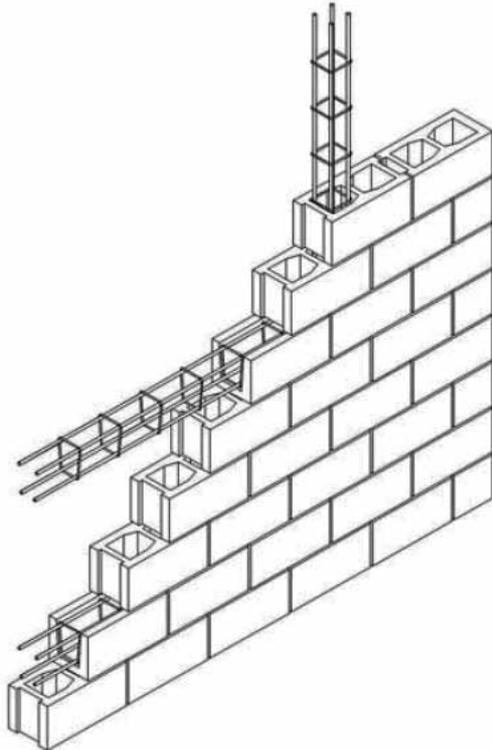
Muro de bloque con zunchos y pilastras interiores de hormigón armado.
